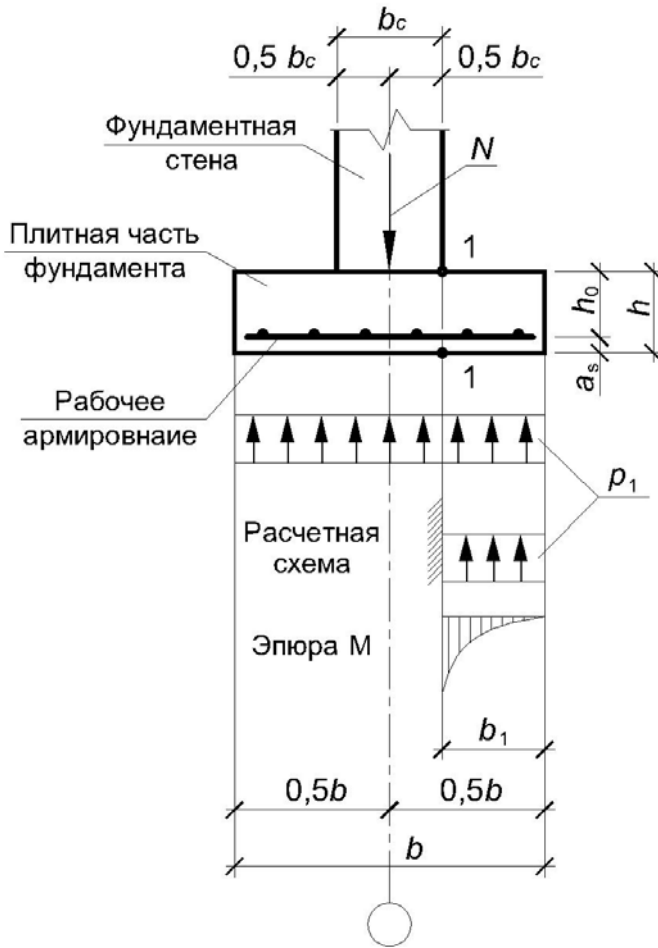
Схема к расчету прочности нормальных сечений плитной части ленточного фундамента:
